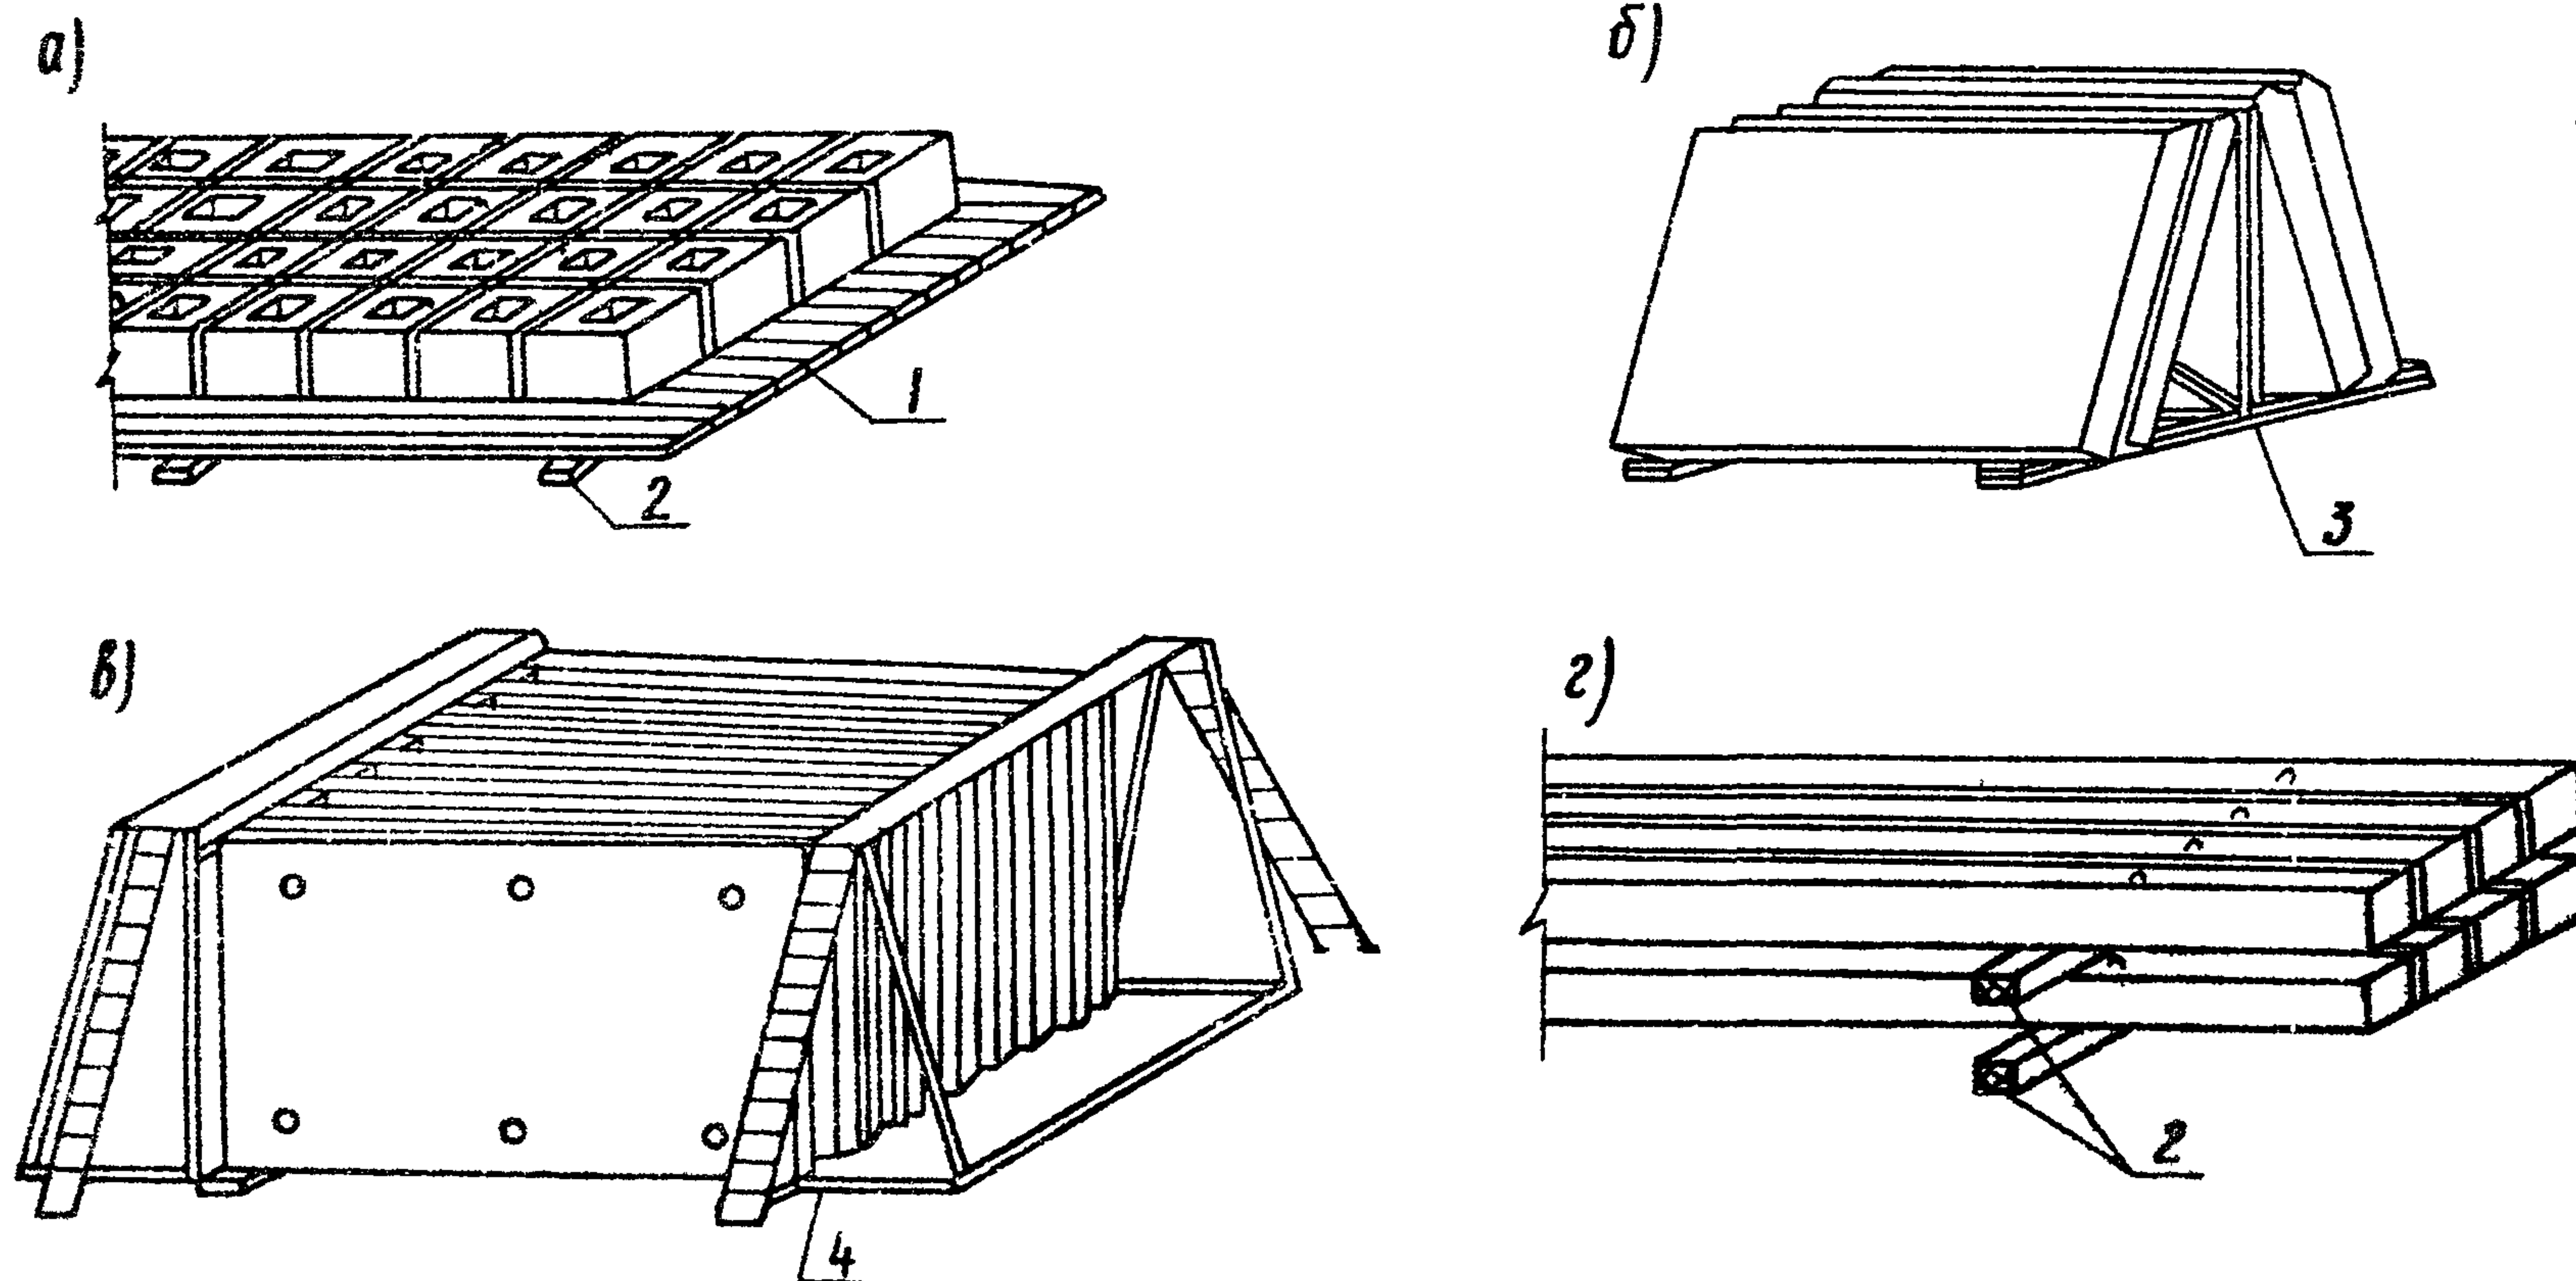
Складирование сборных конструкций: а) оголовков; б) цокольных панелей; в) панелей перекрытий; г) ростверков и балок. 1-настил из досок 40мм; 2-подкладка 80x80мм; 3-металлическая пирамида на 4 цокольные панели; 4-кассета конструкции Гирооргсельстроя
